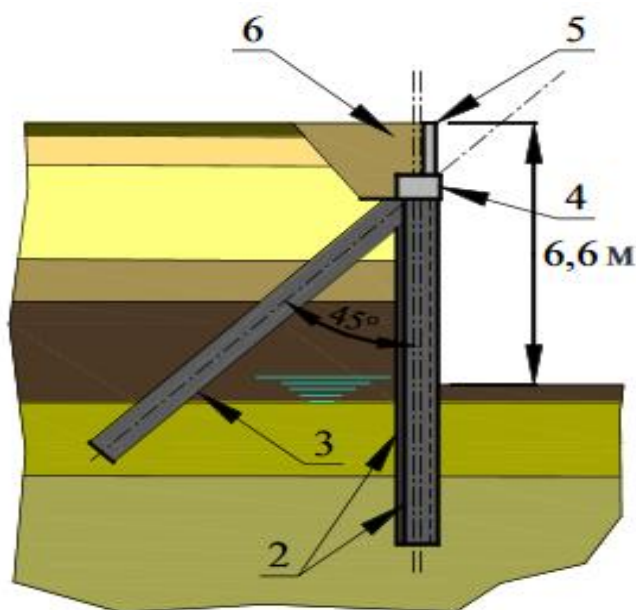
Конструкція обгороджування і постійного кріплення котловану: 2 – вертикальні ґрунтоцементні палі огороження котловану; 3 – анкерна ґрунтоцементна паля постійного кріплення котловану; 4 – монолітна залізобетонна обв'язувальна балка ; 5 – залізобетонна стіна; 6 – зворотна засипка піском
